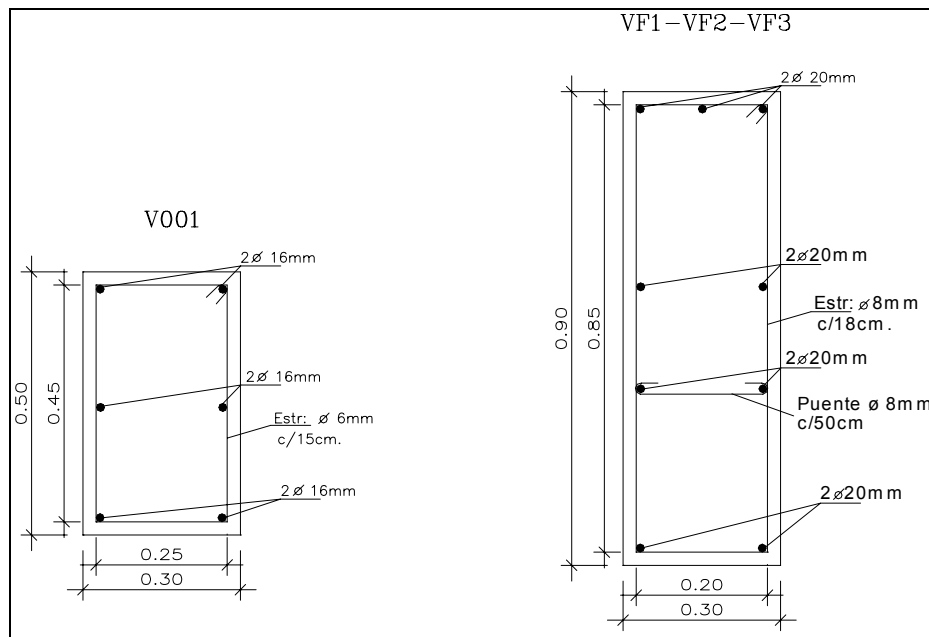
Secciones y detalles de disposición de armaduras en vigas de fundación no incorporadas a bases corridas.
